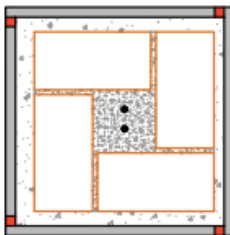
Refuerzo de pilar mediante encamisado metálico completo. Fuente propia.
